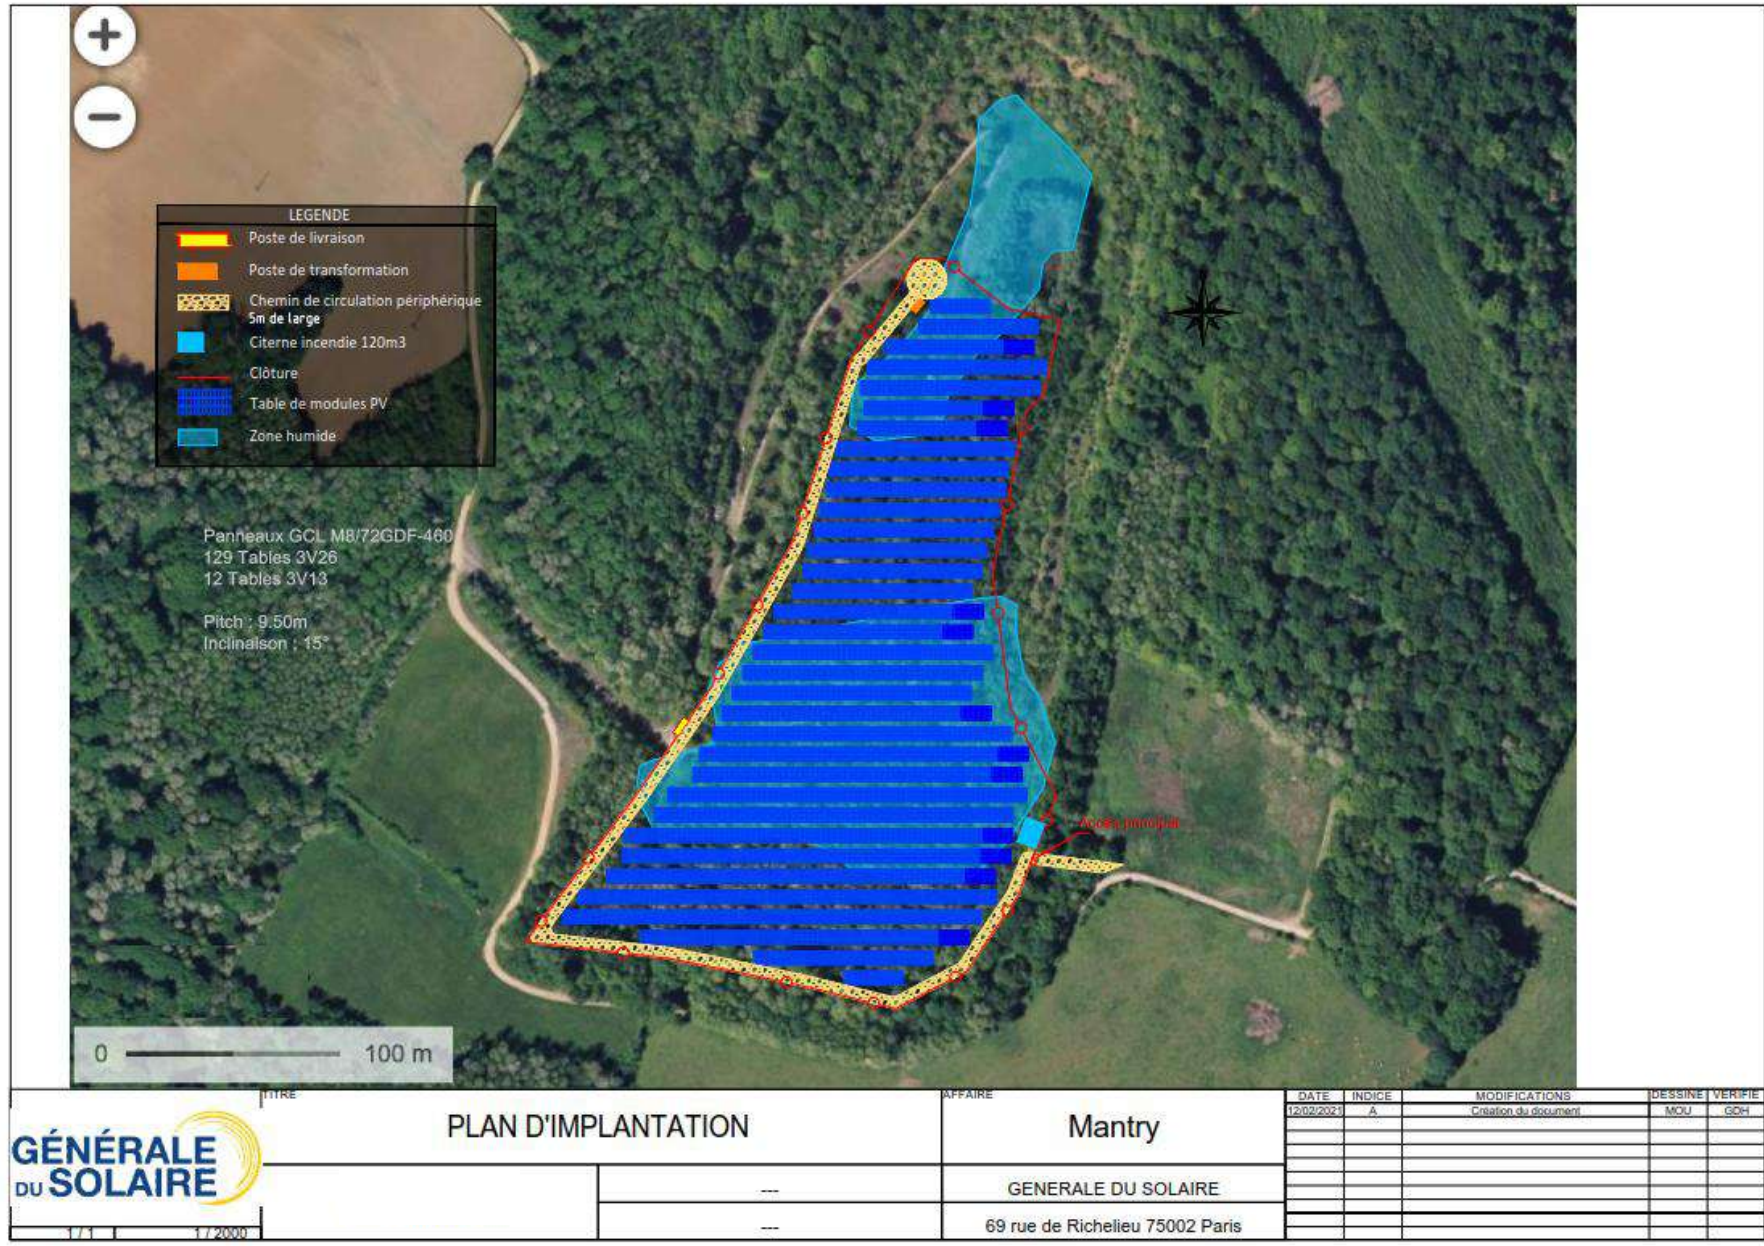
Plan d'implantation générale du projet de centrale solaire
